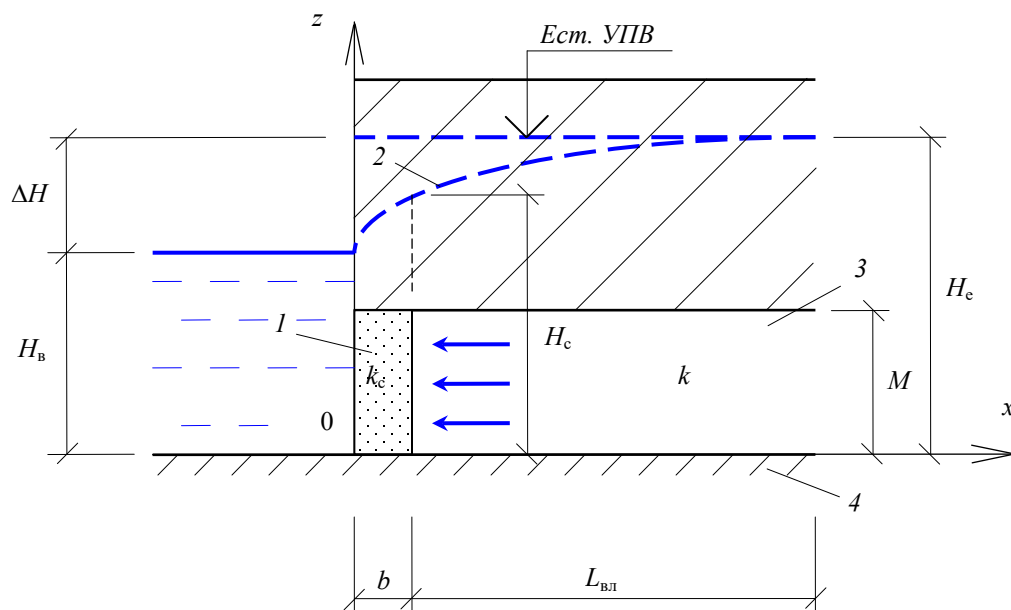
Расчётная схема водоотлива из строительной выработки:
